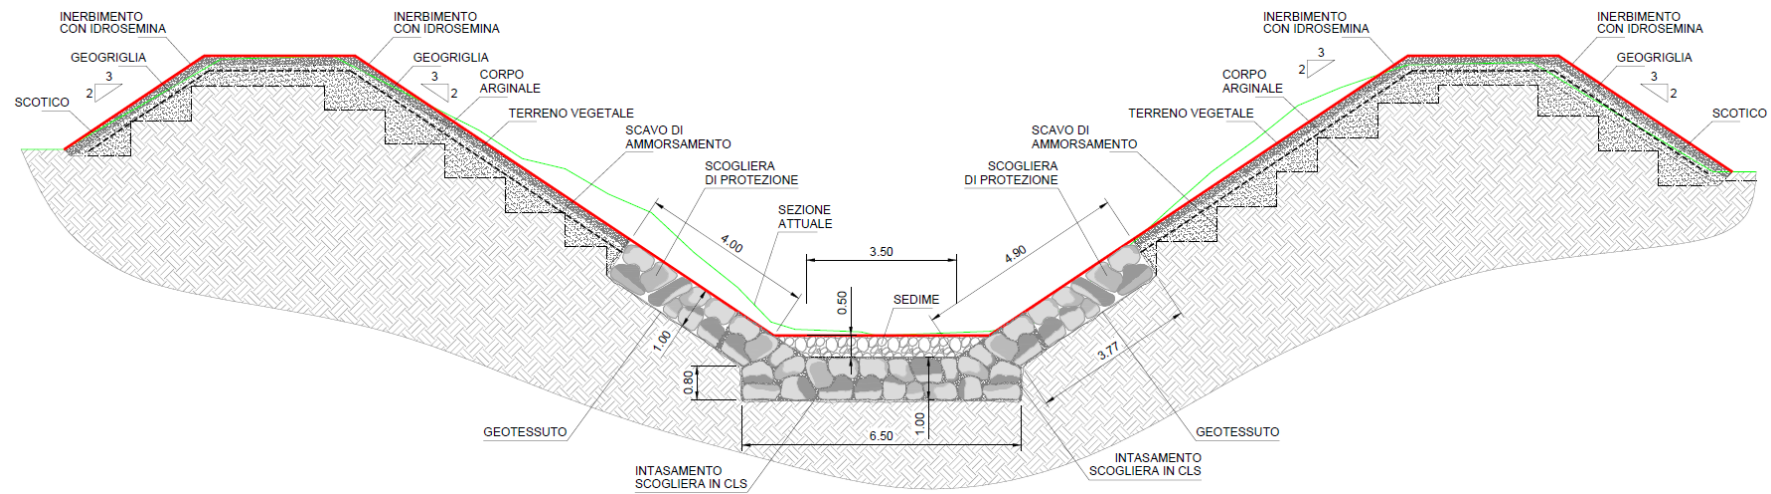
Sezione tipo intervento con soglia di fondo progetto preliminare [4] (scala 1:200).
